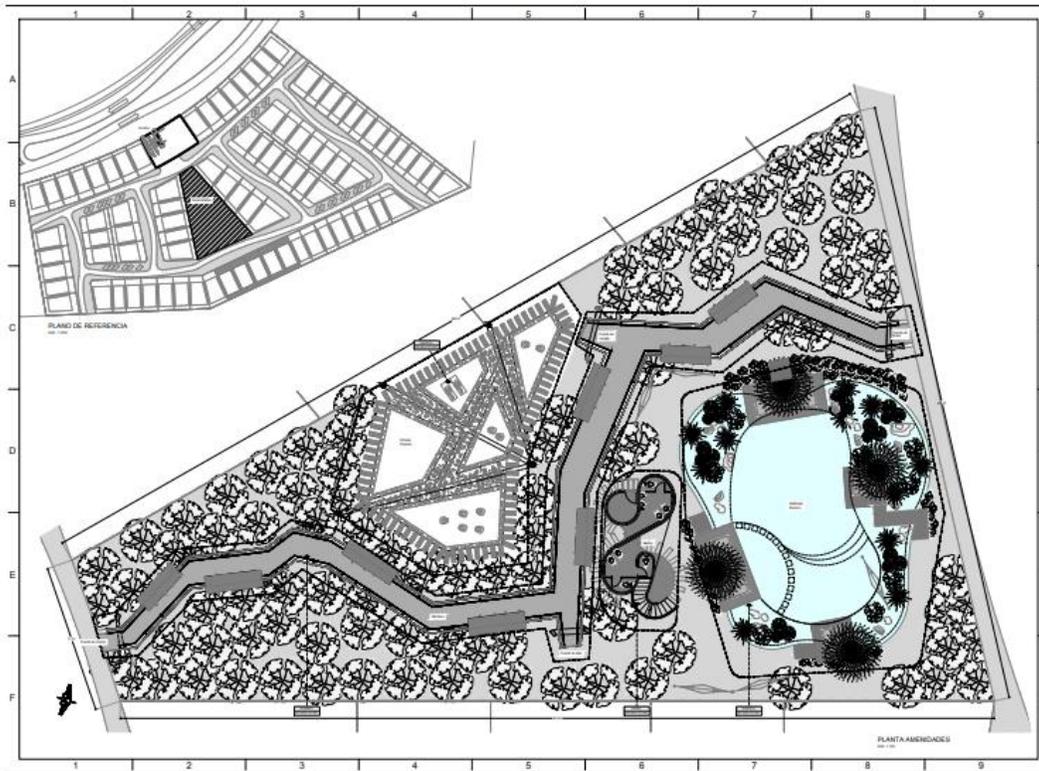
Plano arquitectónico de las amenidades del conjunto.
